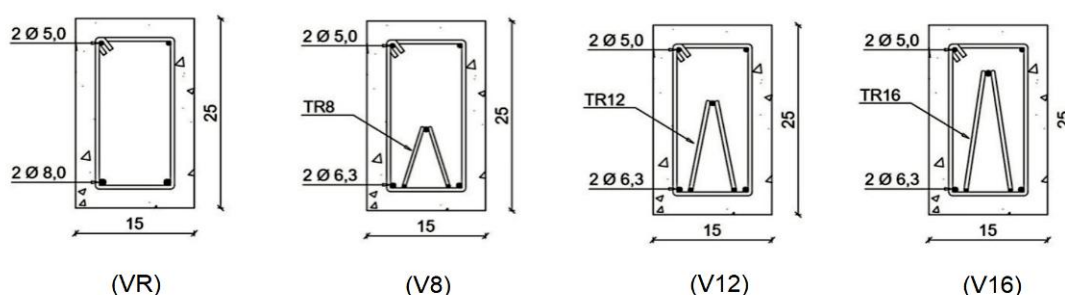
Detalhamento da armadura utilizada em cada grupo.
